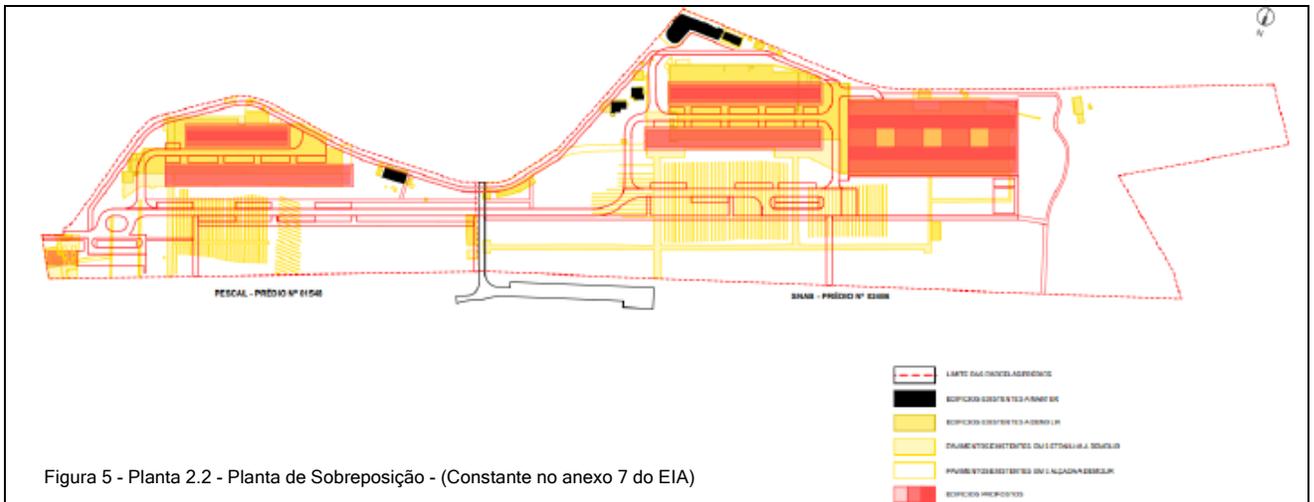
Planta 2.2.2 - Planta de Sobreposição - (Constante no anexo 7 do EIA)
